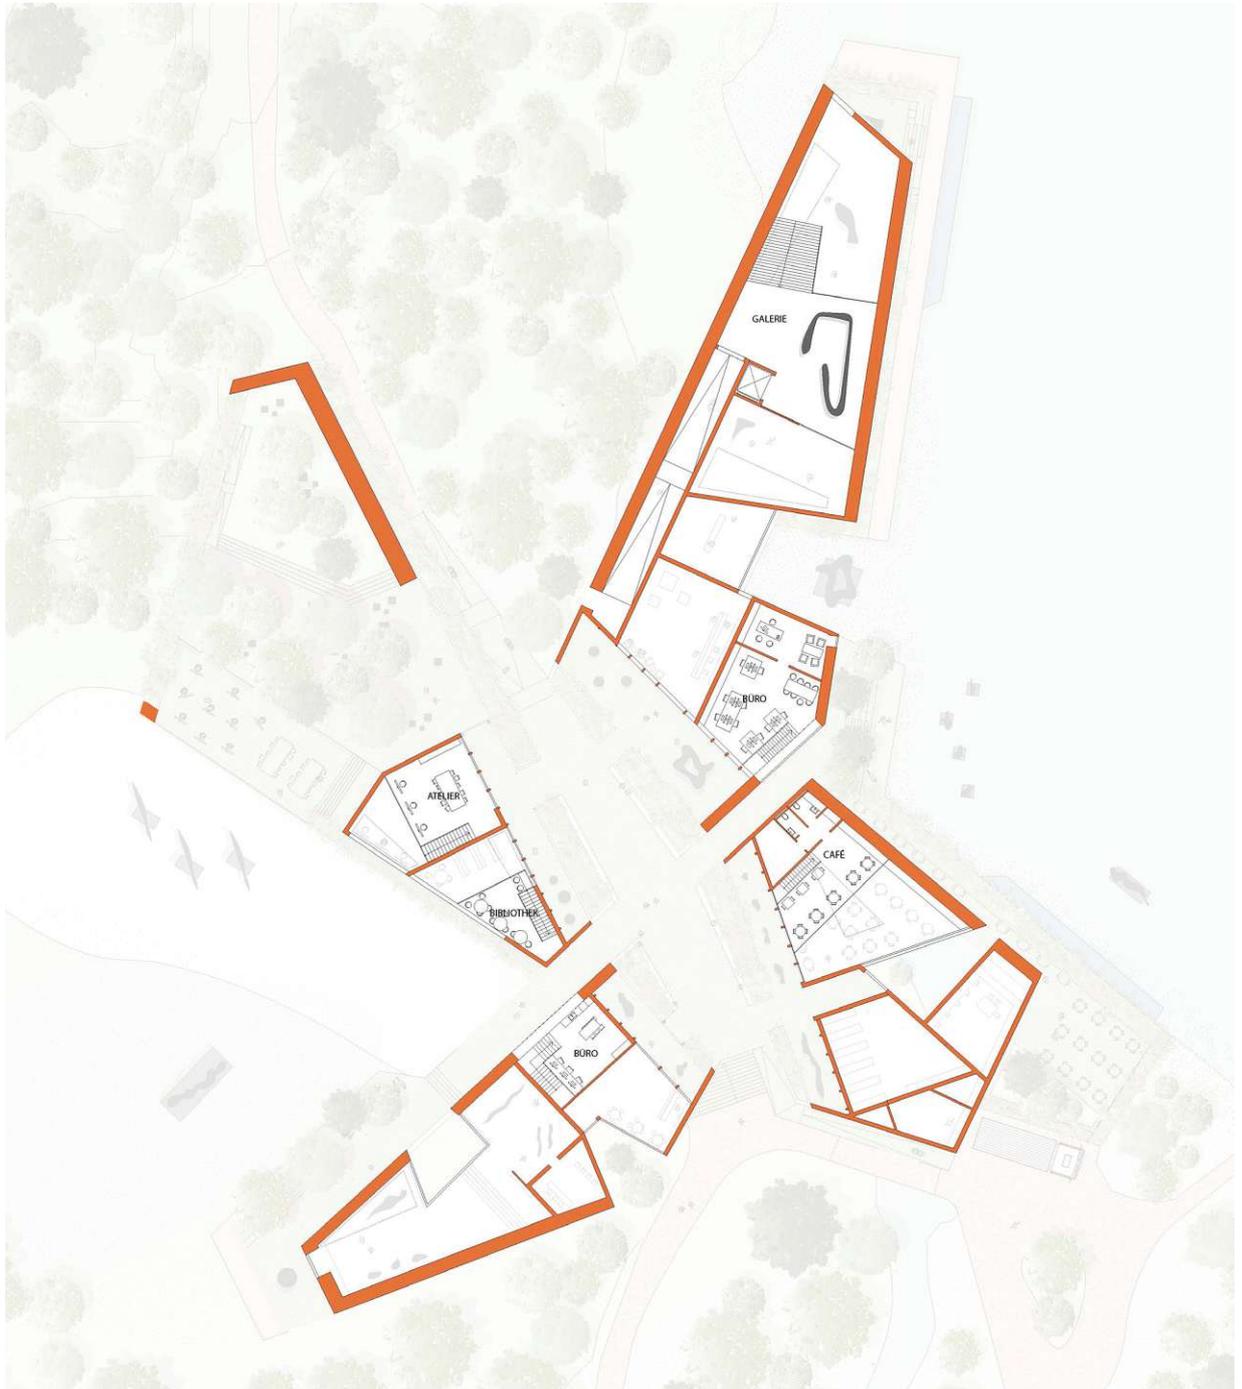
Grundriss Obergeschoss | +5 Meter | 1:500
